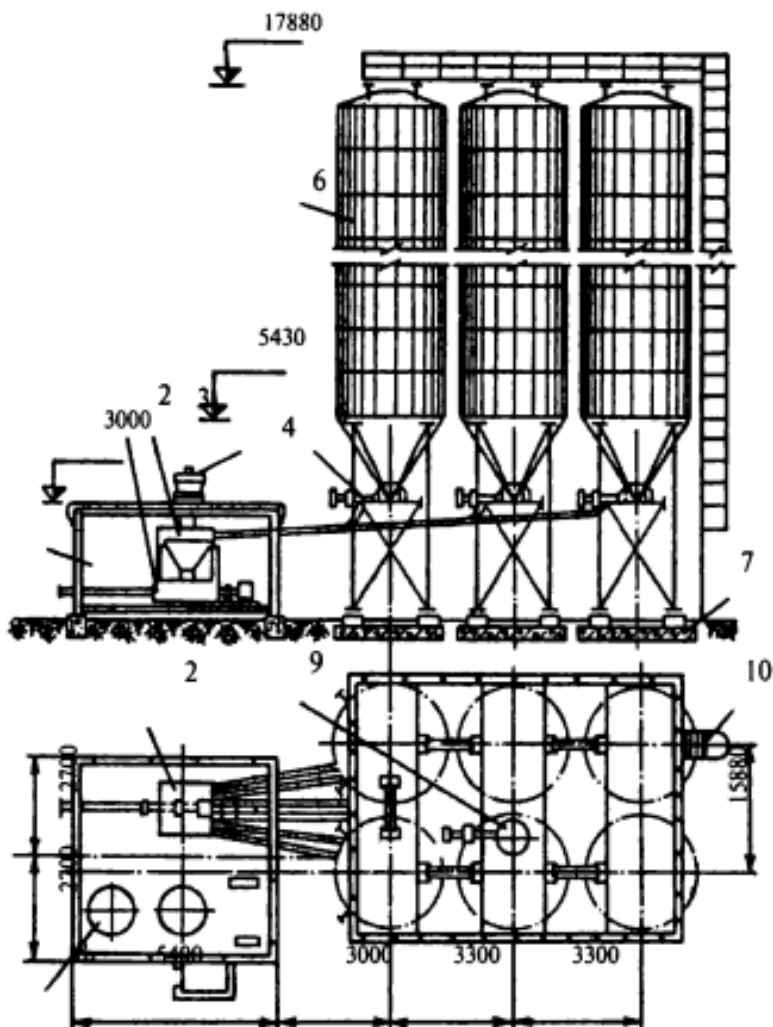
Инвентарный притрассовый склад цемента емкостью от 240 до 720 т: 1 – насосно-фильтровое помещение; 2 – пневмонасос; 3 – собирательный бункер; 4 – фильтр; 5 – донный пневморазгрузатель; 6 – силосы; 7 – поверхностные железобетонные опорные плиты; 8 – фильтры для обезвоживания сжатого воздуха; 9 – рукавный фильтр; 10 – лестница.
